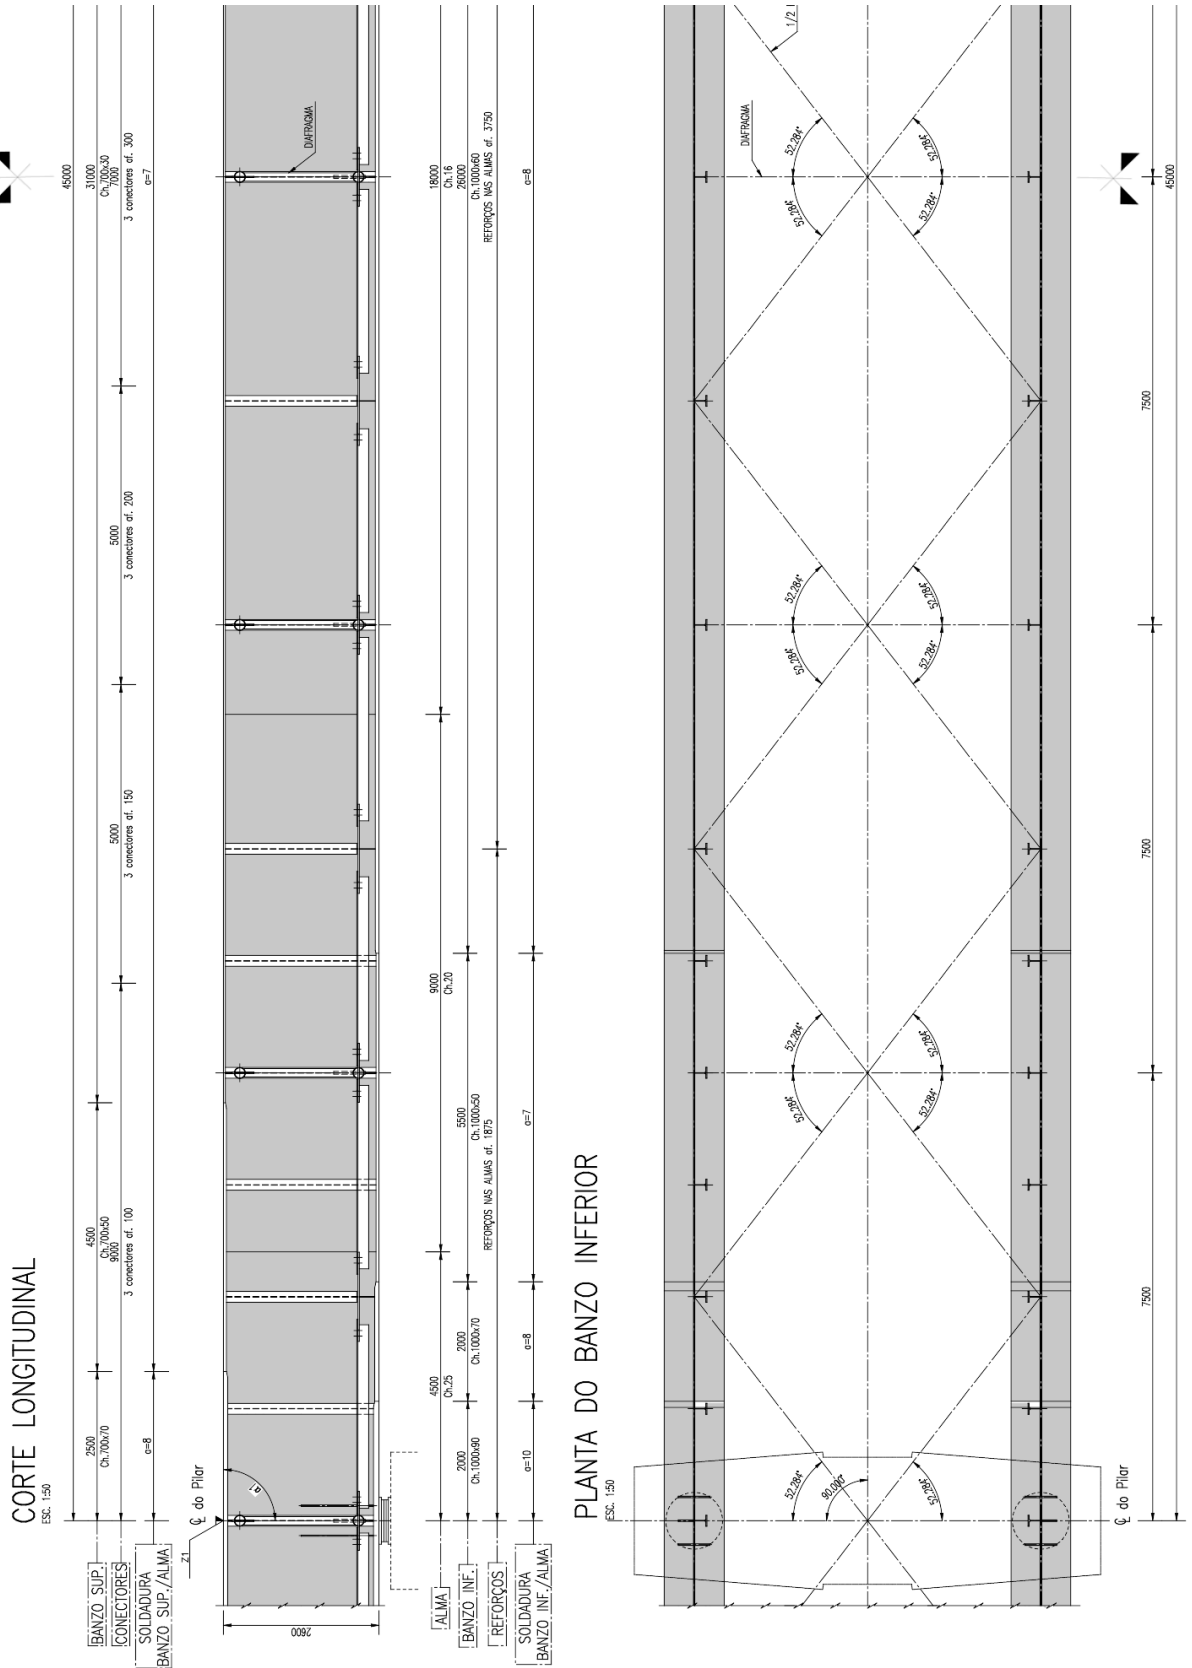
Viaduto Sul de acesso à Ponte do Sado: Alçado e planta de meio tramo tipo [1]
